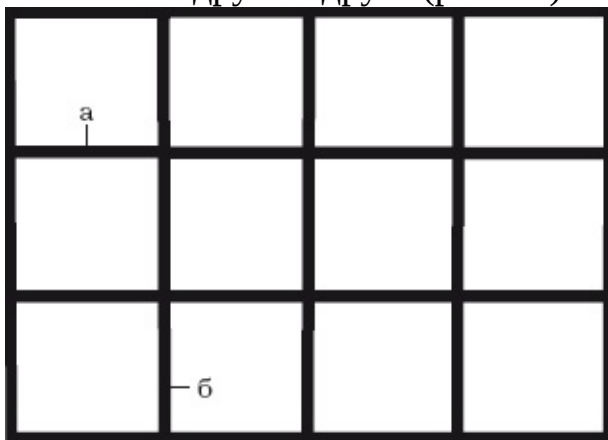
Установка каркаса плиточного подвесного потолка: а – направляющие; б – соединительные элементы
